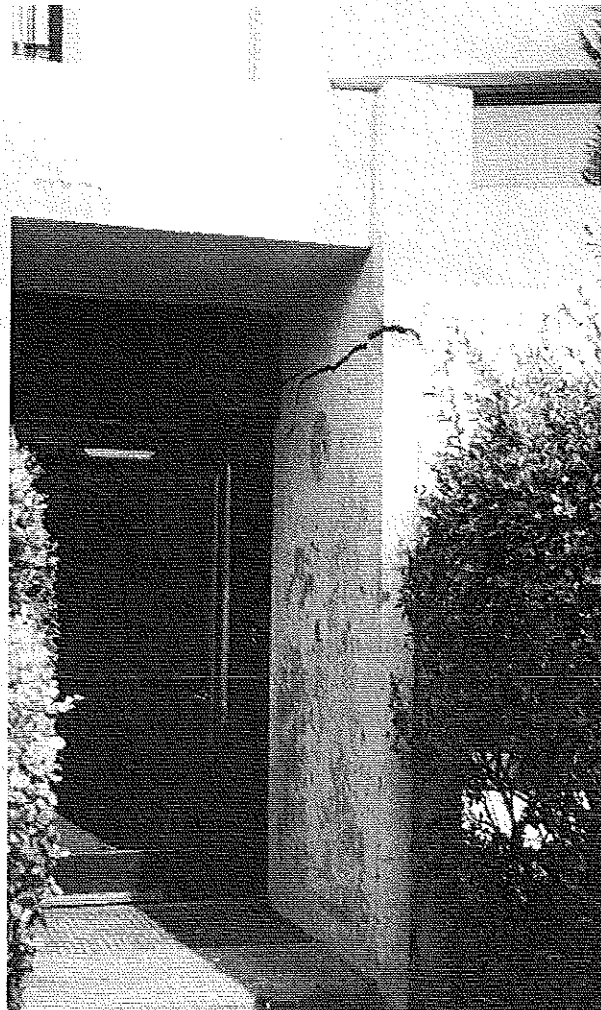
Entrée de l'immeuble (en avancée de façade).
